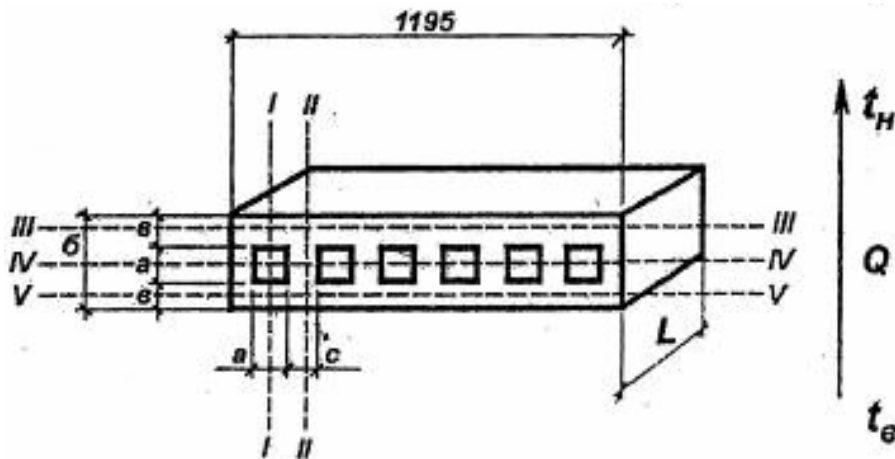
Расчетное сечение плиты перекрытия
